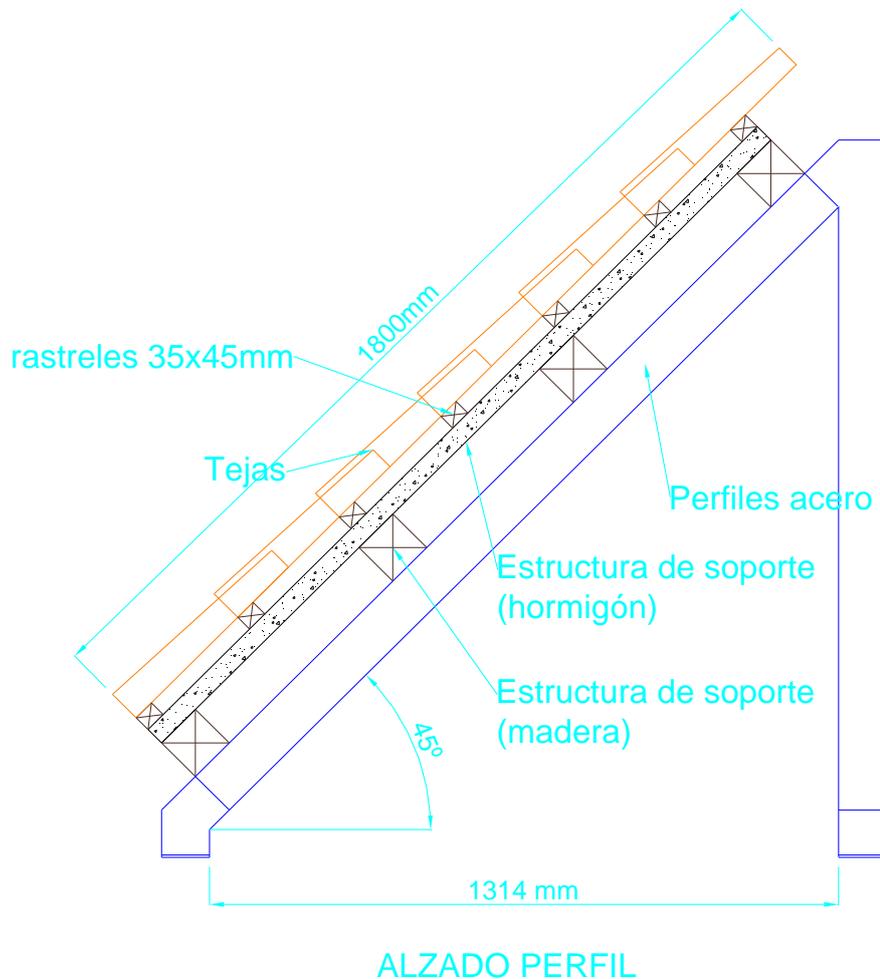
Perfil de la estructura de soporte con la disposición de las tejas
